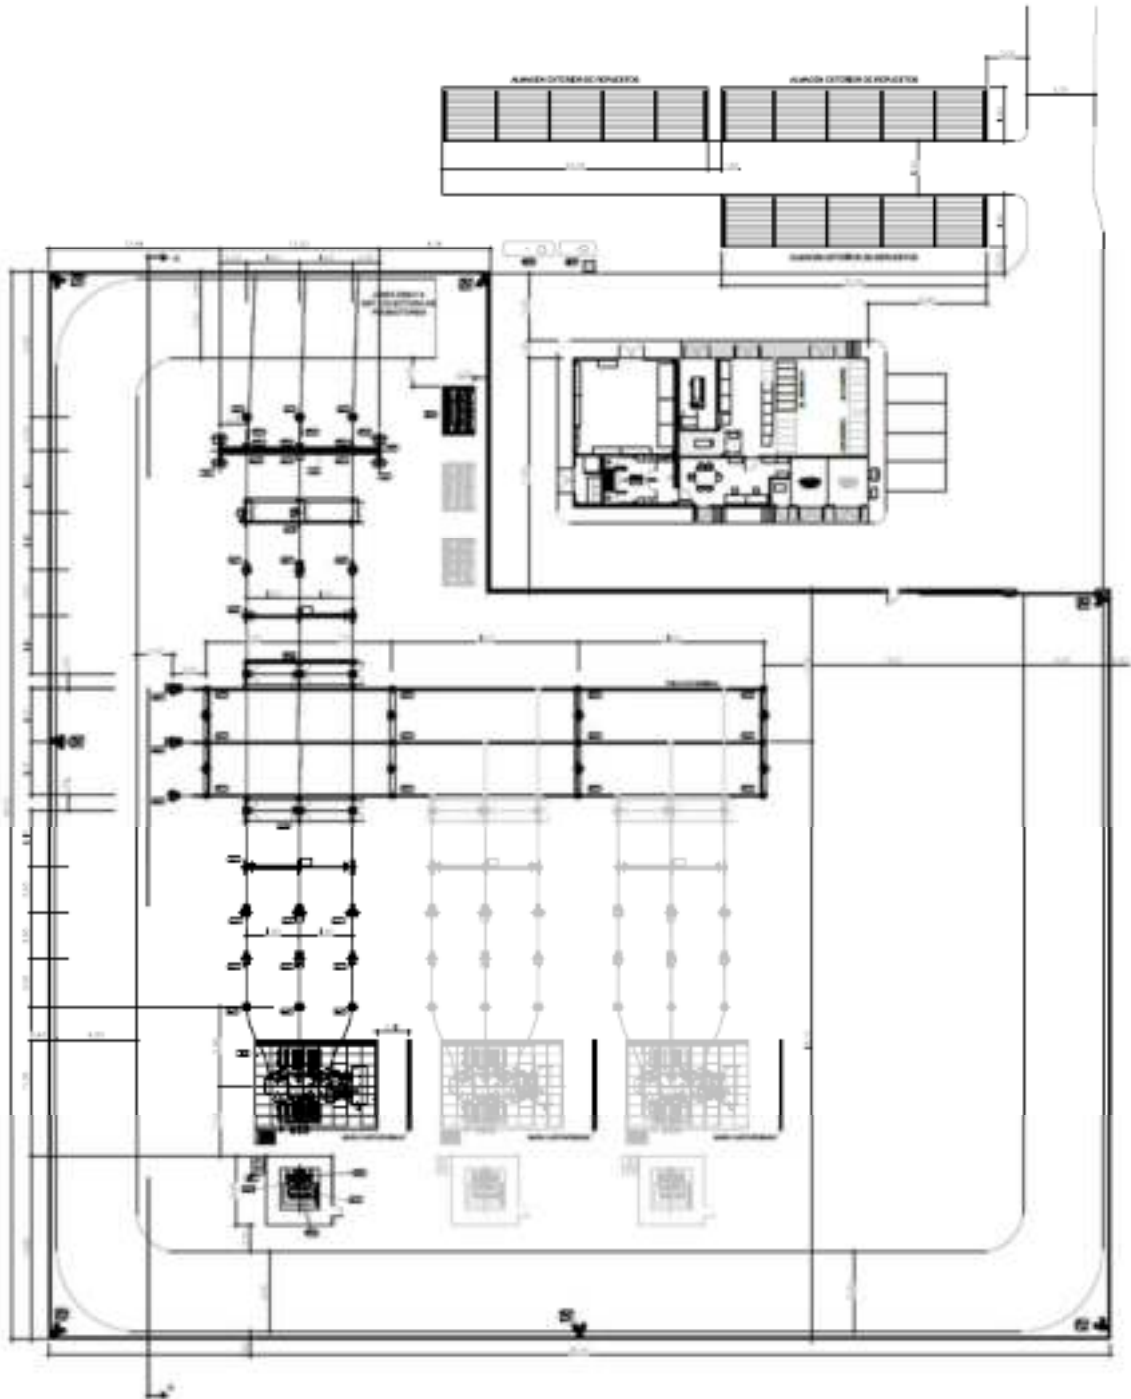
Detalle de subestación y edificio de control (planta).
